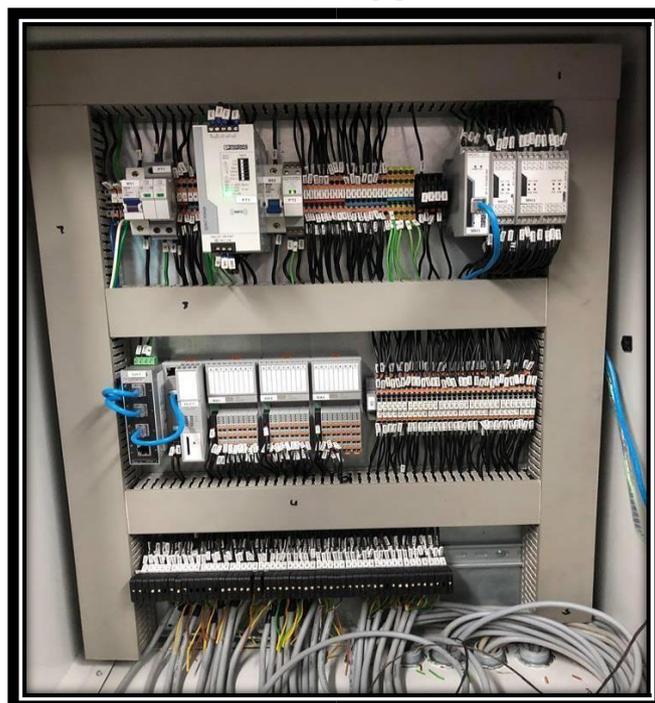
Panel de control Planta de Tratamiento, ASP
